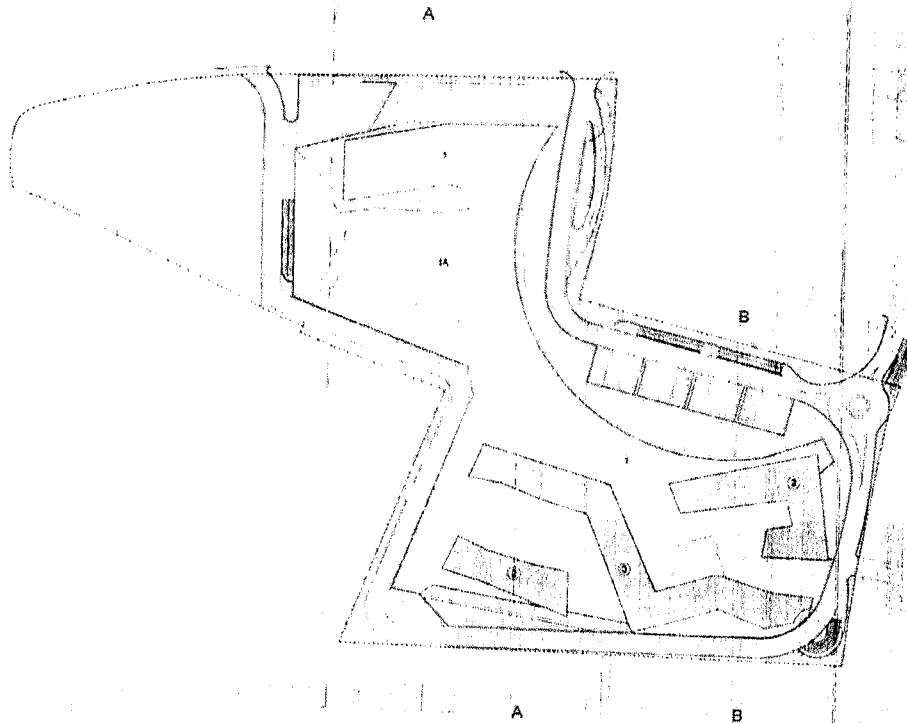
Estratto Permesso di Costruire n. 68/2005: planimetria generale.
